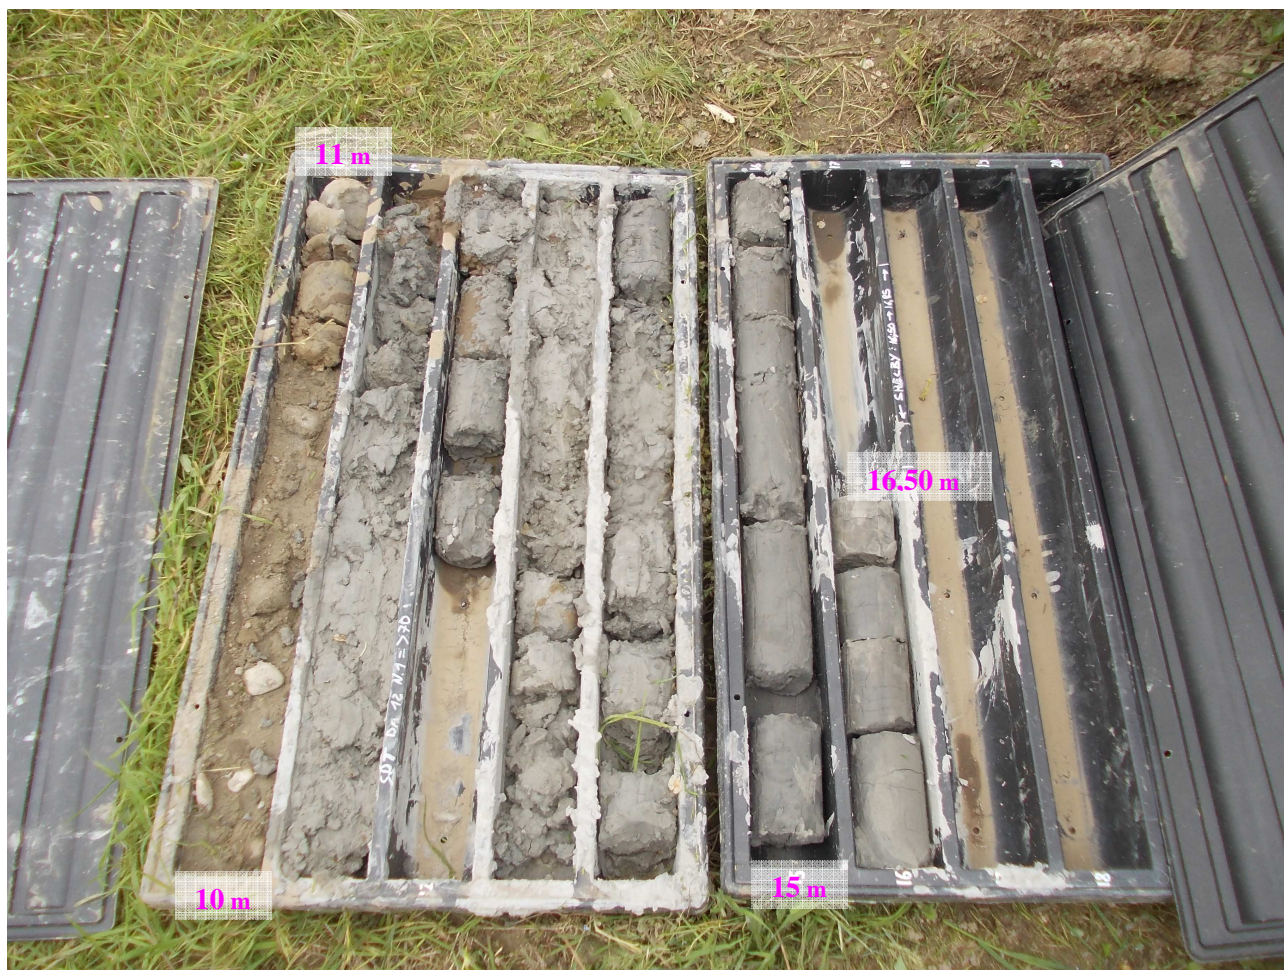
Sondaggio S2/2014- Sito Via San Lorenzo. Cassetta dei campioni prelevati, a carotaggio continuo, da 10,00 m a 16,50 m.
